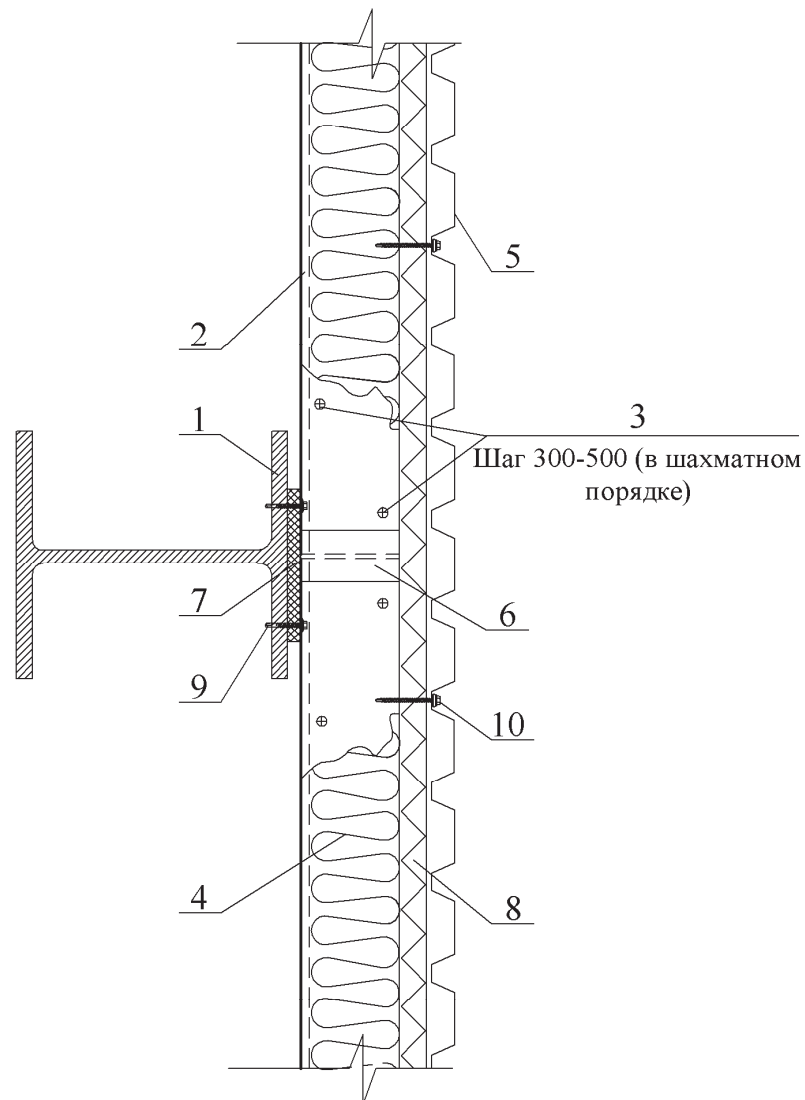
Вертикальный разрез ограждающих конструкций стен из сэндвич - профиля
